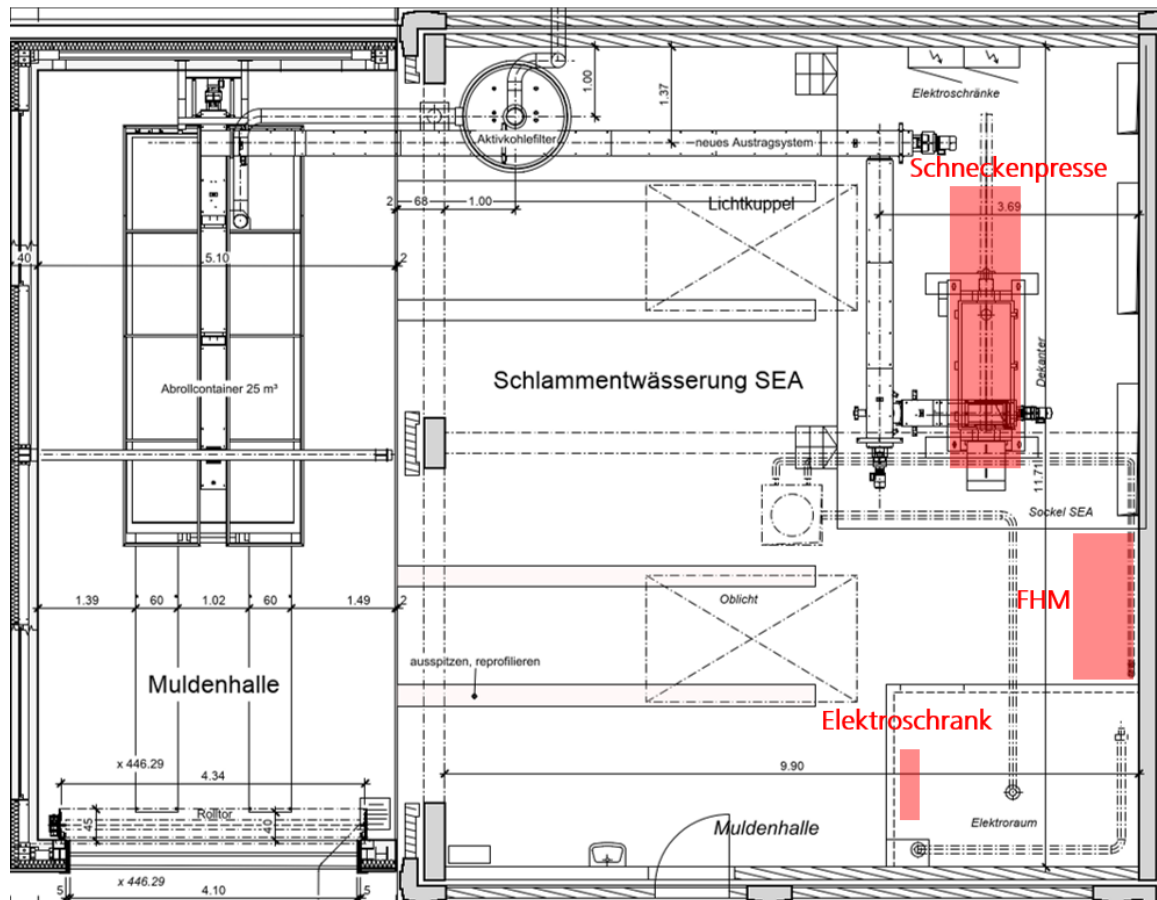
Situationsplan Entwässerungshalle Erdgeschoss und neue Aufstellung SEA
